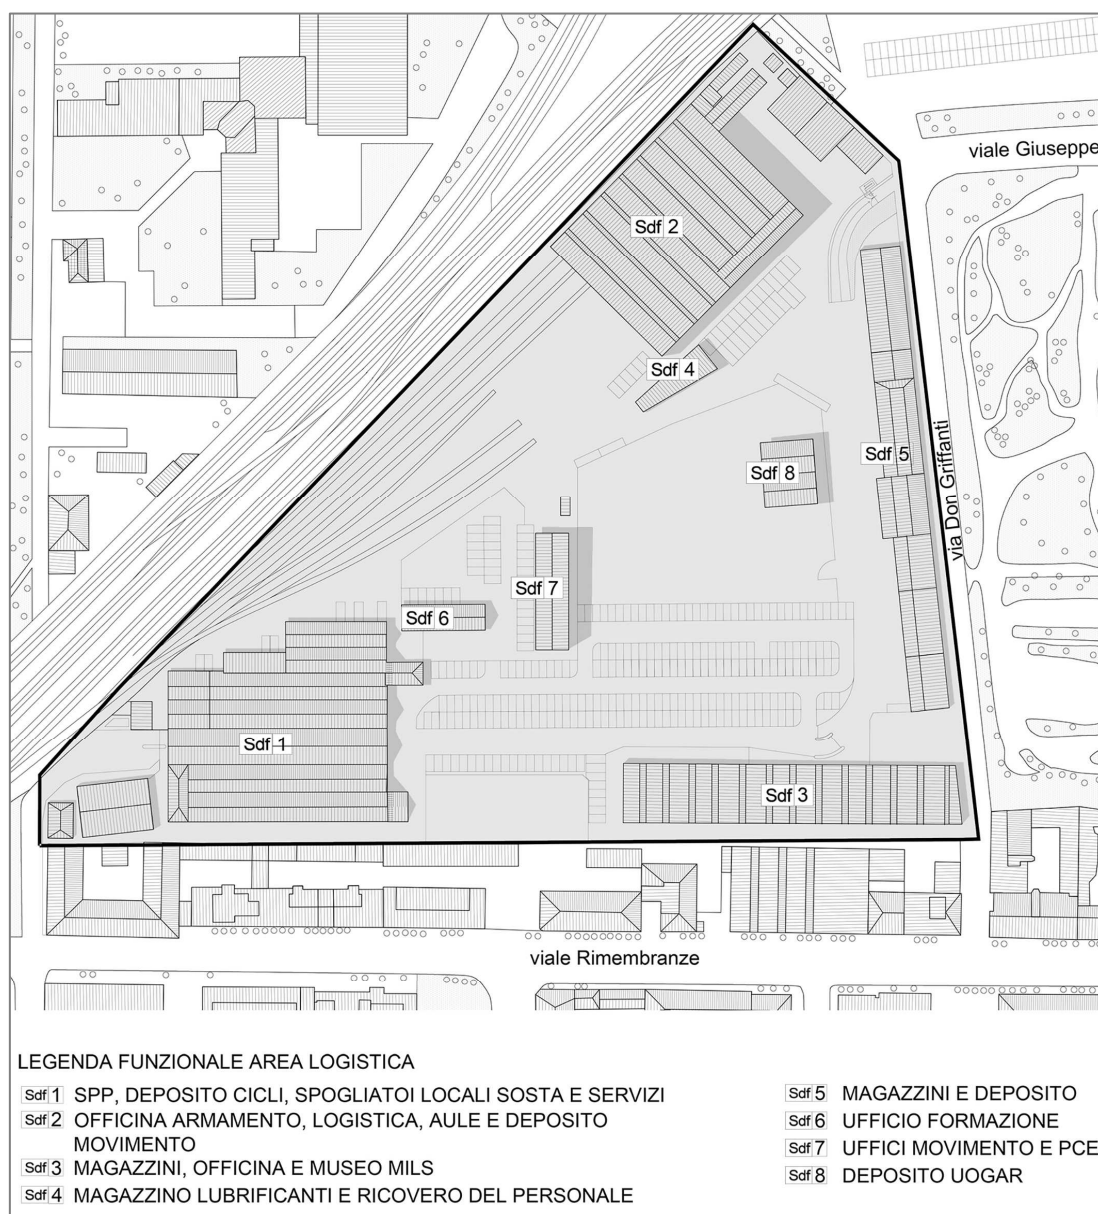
schema planimetrico stato di fatto con indicazione degli edifici
